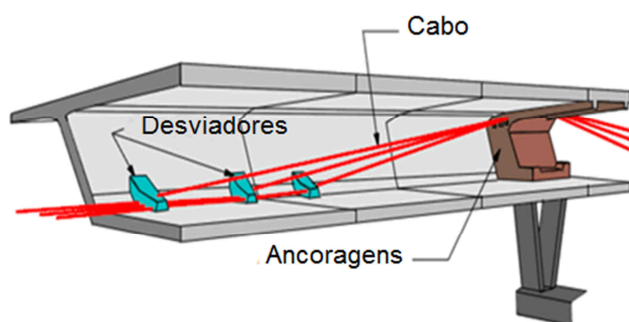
Disposição dos cabos de pré-esforço exterior (Suntharavadivel 2008).
